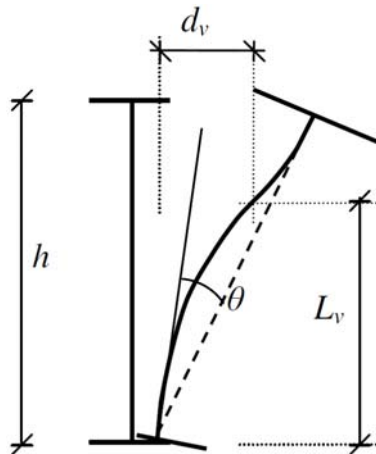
Rotirea corzii pentru o structură în cadre de beton armat [1]
